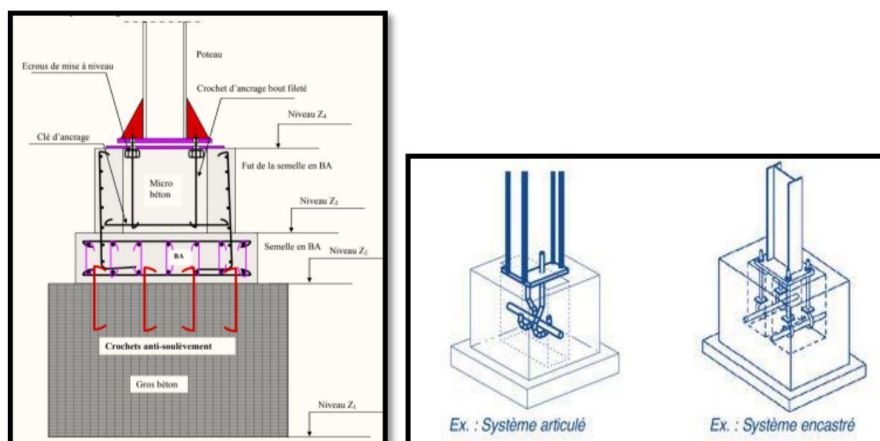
Exemple de poteau métallique avec fondation en béton armé / source : google image
